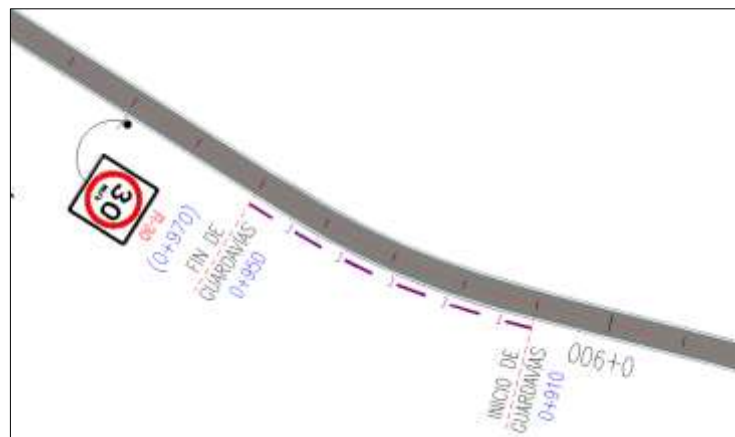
Guardavias en planta. Fuente plano de Señalización y seguridad Vial SSVV.01
